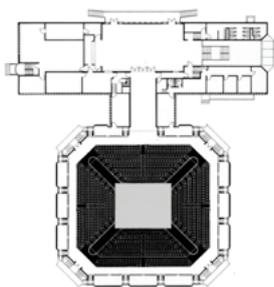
Planta del teatro Arena Stage, Washington D.c, Estados Unidos, 1962. Harry Wesse.
